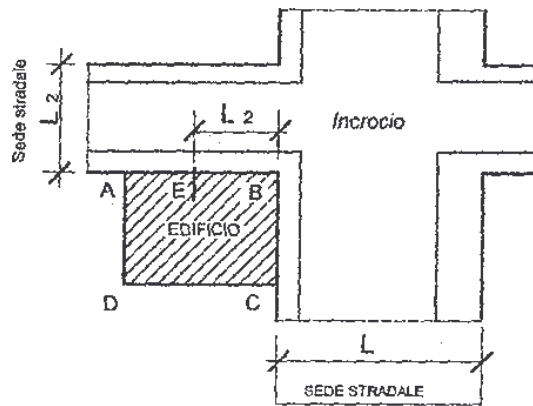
Esempio di edificio in angolo su strade di diversa larghezza
